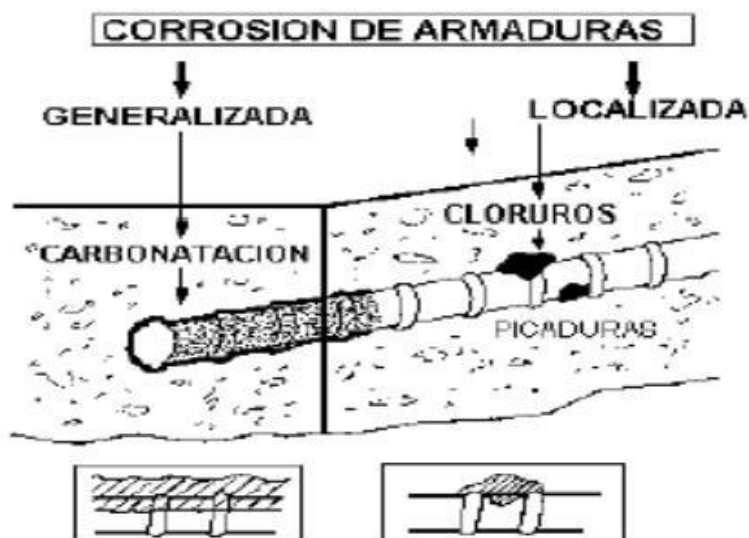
Tipos de corrosión que se pueden dar en las barras de acero de una estructura de hormigón armado.. Fuente: Salas, J. E. 2003
